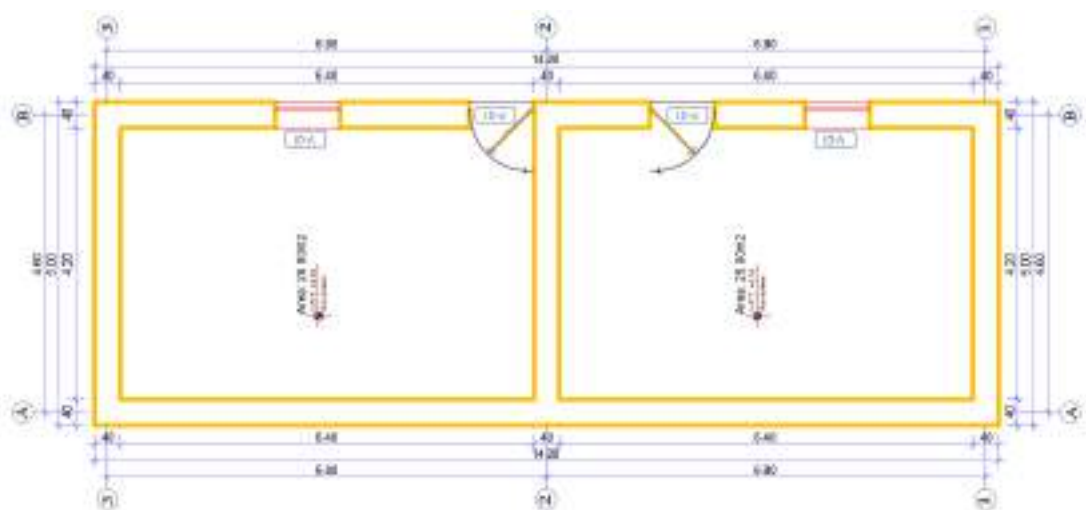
Distribución en planta de la vivienda rectangular desfavorable.
